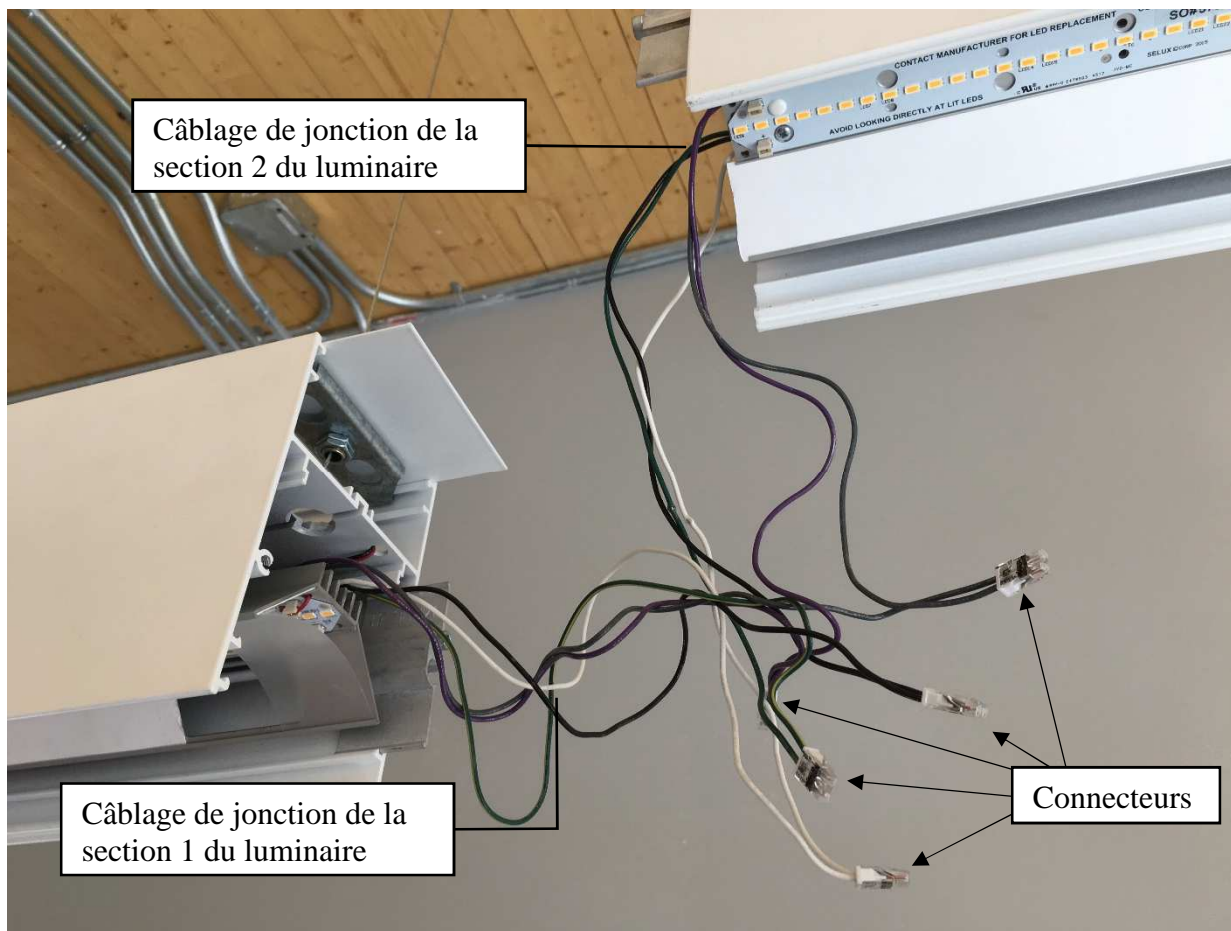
Câblage de jonction des sections 1 et 2 du luminaire
